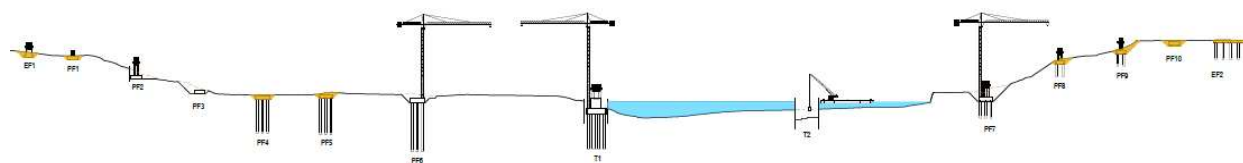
Faseamento construtivo – Etapa 1 de 6
